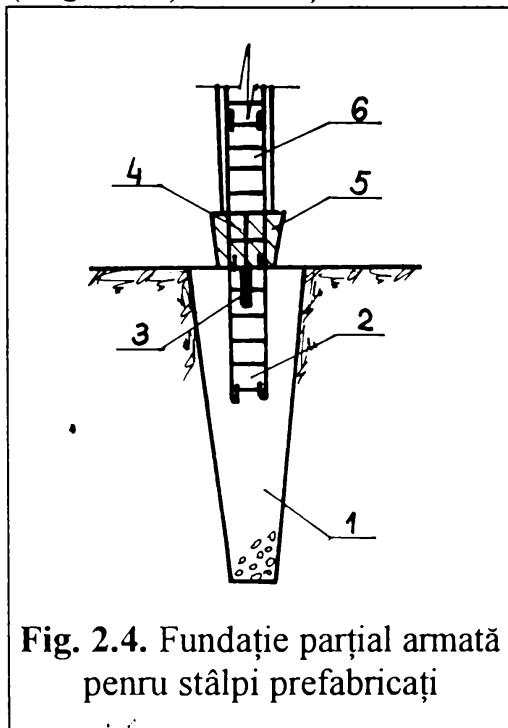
Fundație parțial armată pentru stâlpi prefabricați
